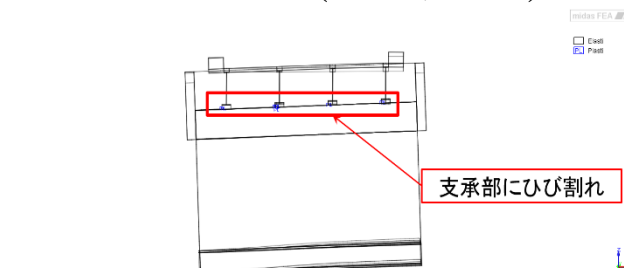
ひび割れ形状(橋軸直角方向, 洗掘 40%)
